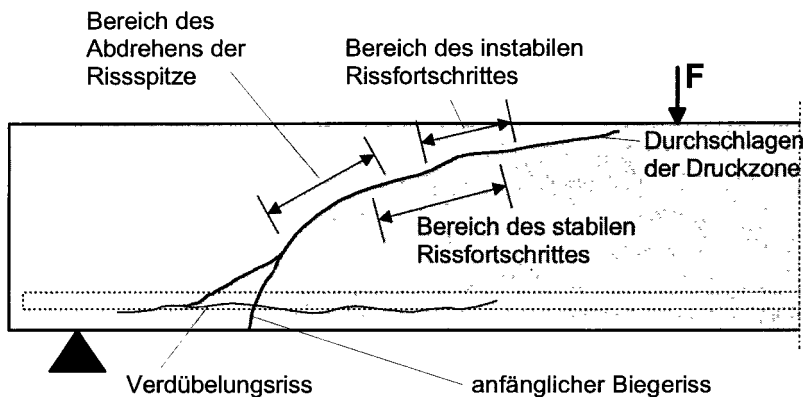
Biegeschubversagen von Balken mit Stahlfasern und ohne Bügelbewehrung [105]
